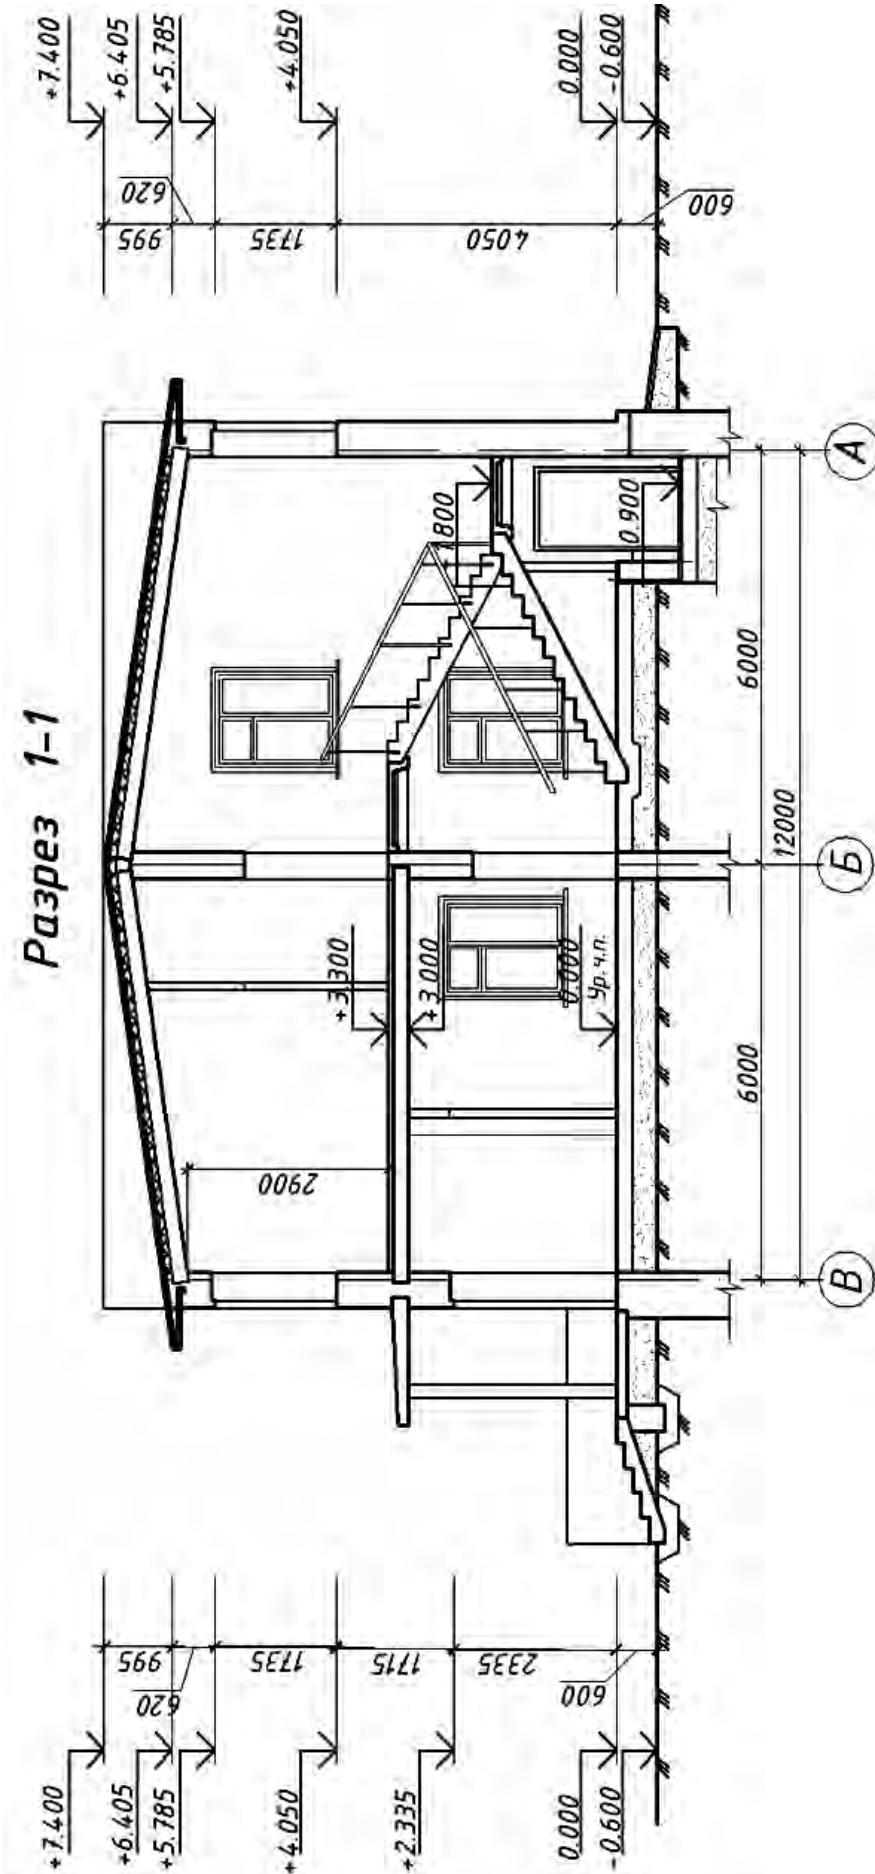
Пример выполнения разреза здания с совмещенной кровлей в масштабе 1:100
